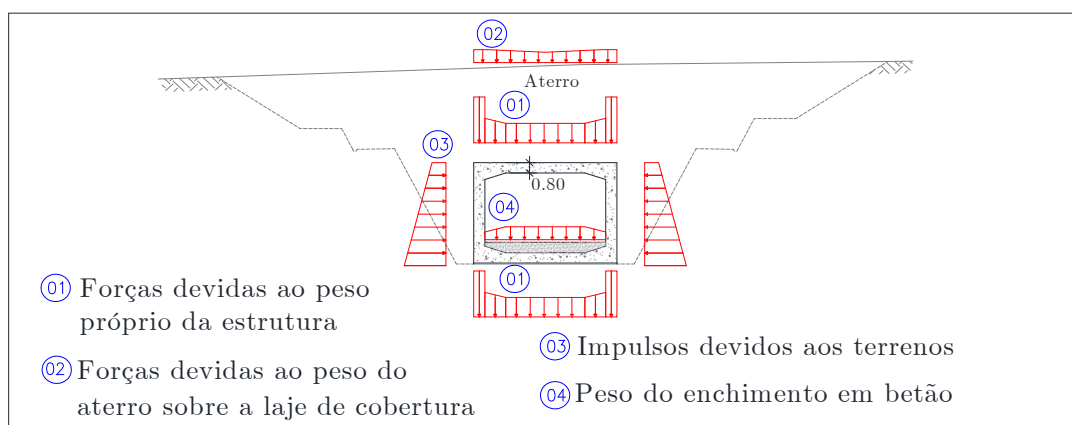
Caso de Carga 1 – Secção com laje de 0.80 situada entre taludes de escavação.
